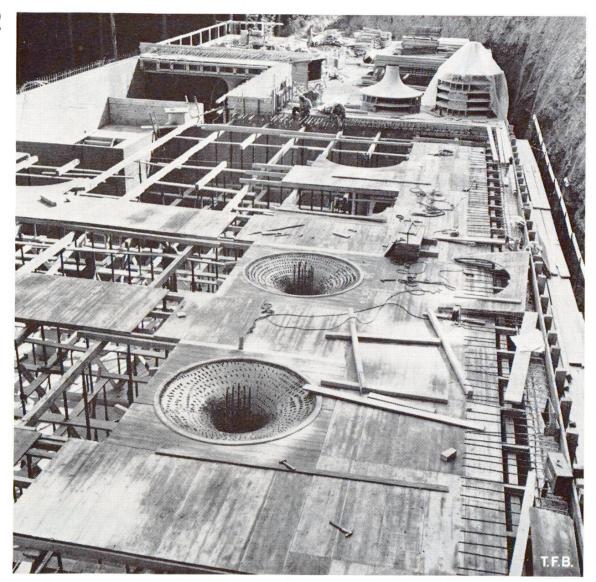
Vue générale du coffrage d'une dalle-champignon pour un grand réservoir à eau.
